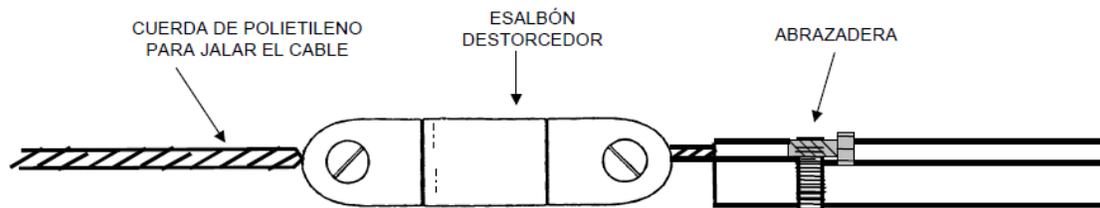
Preparación del cable para su instalación con el eslabón destorcedor.
